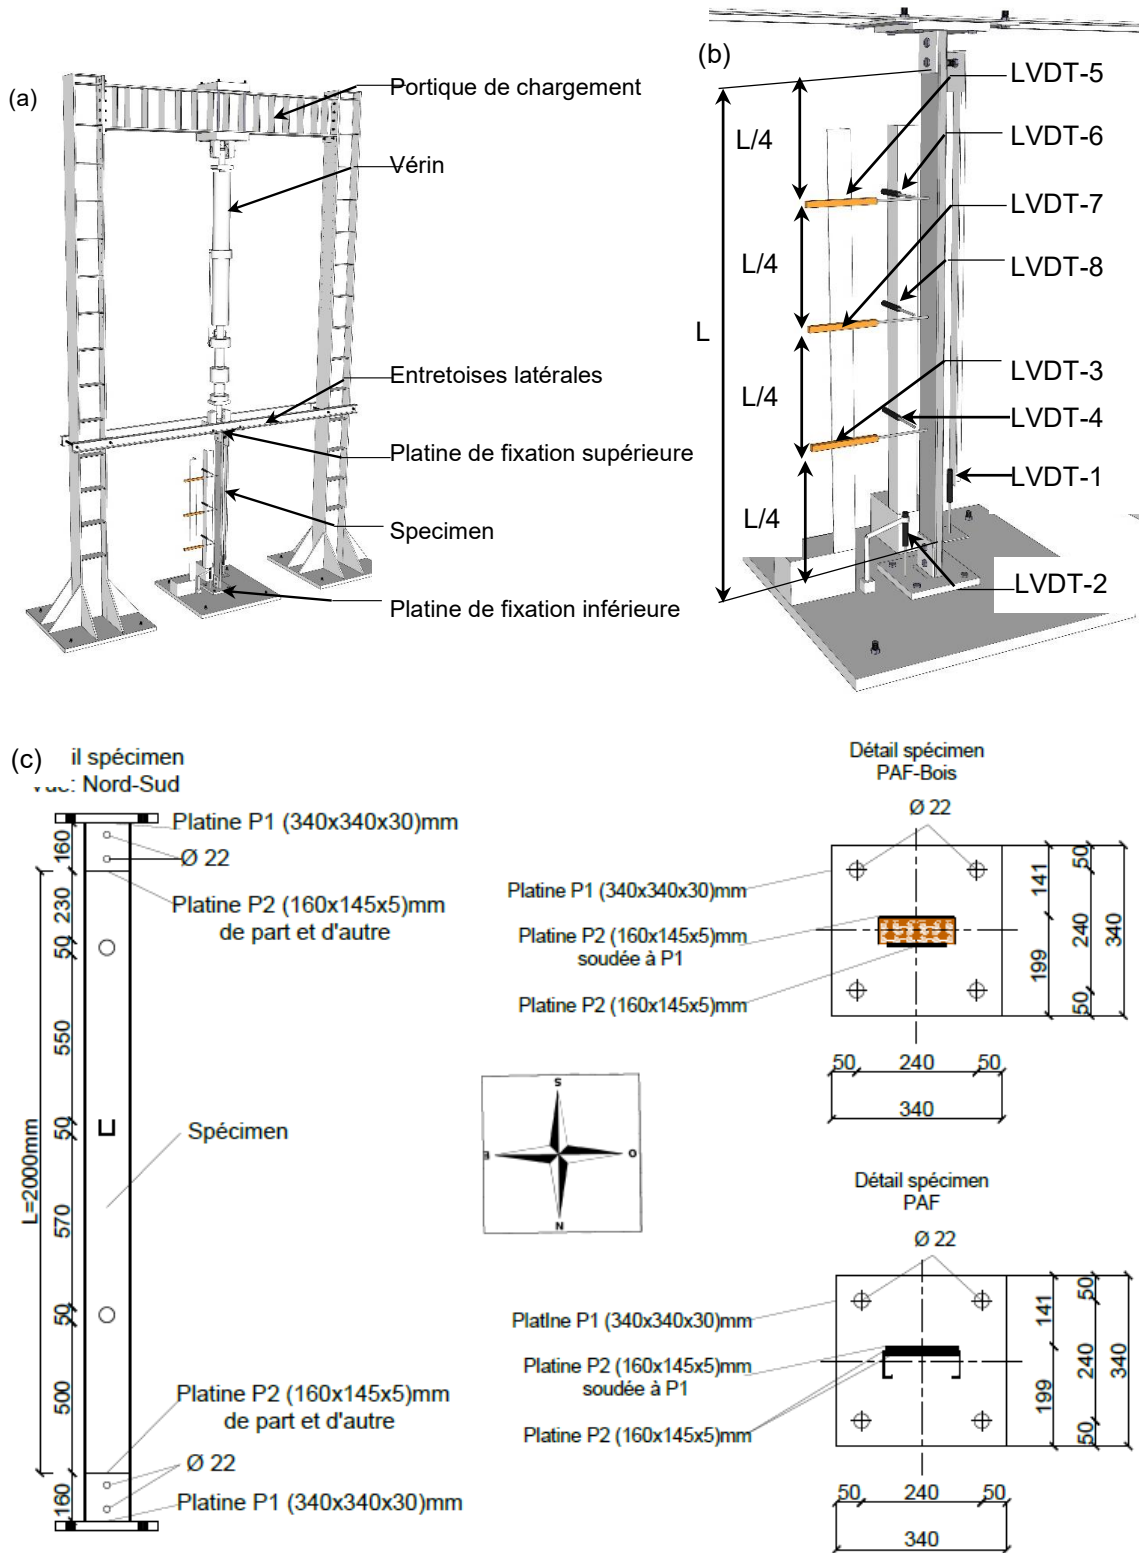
(a) Schéma d'instrumentation: (b) Positions des LVDTs (c) Détails d'assemblage
